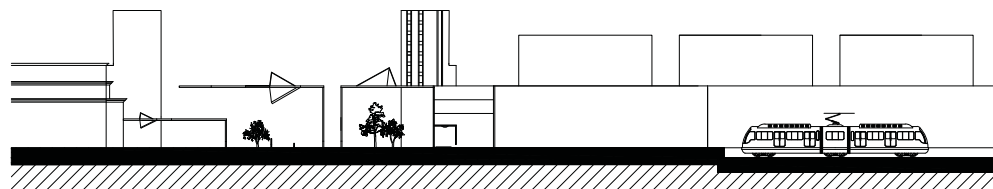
Corte esquemático proyecto y su contexto. Fuente elaboración grupal
